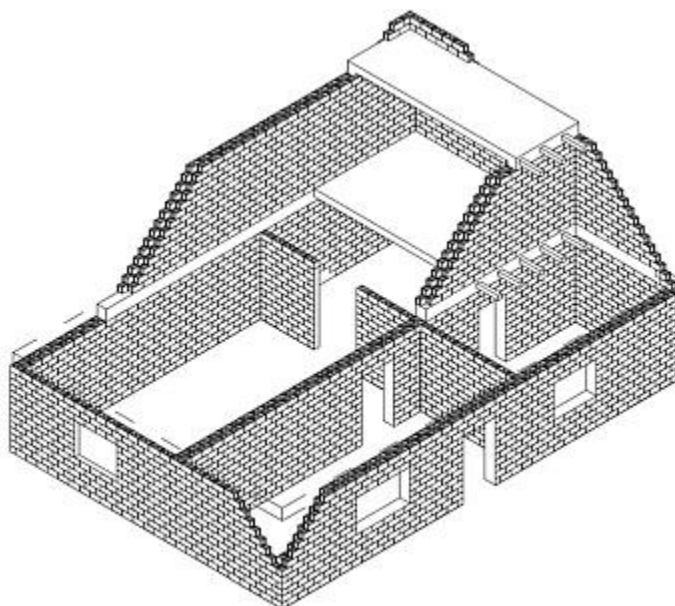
Estructura muraria. Fuente: www.construmatica.com
